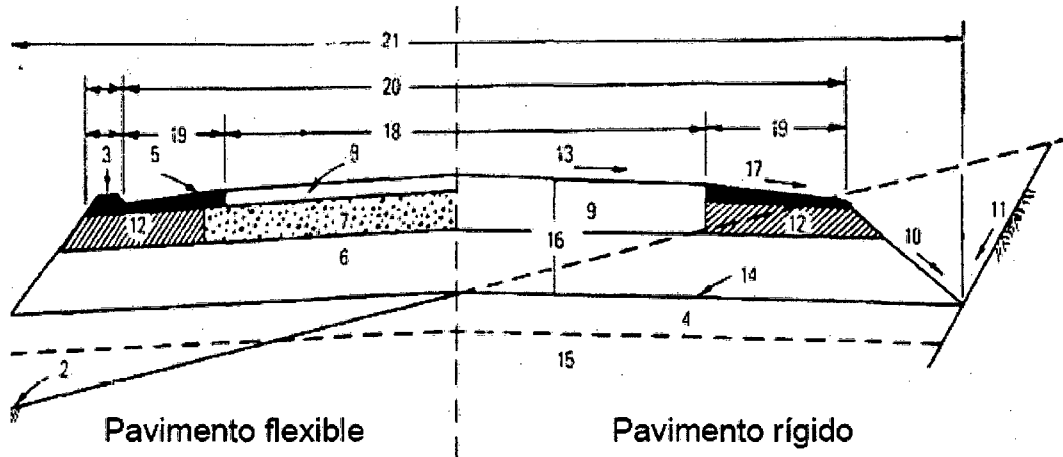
Estructura típica de un Pavimento (Flexible y Rígido)¹¹
